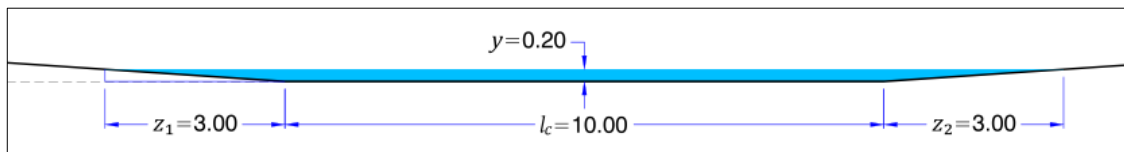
Diseño en planta de Badén en tramo recto
